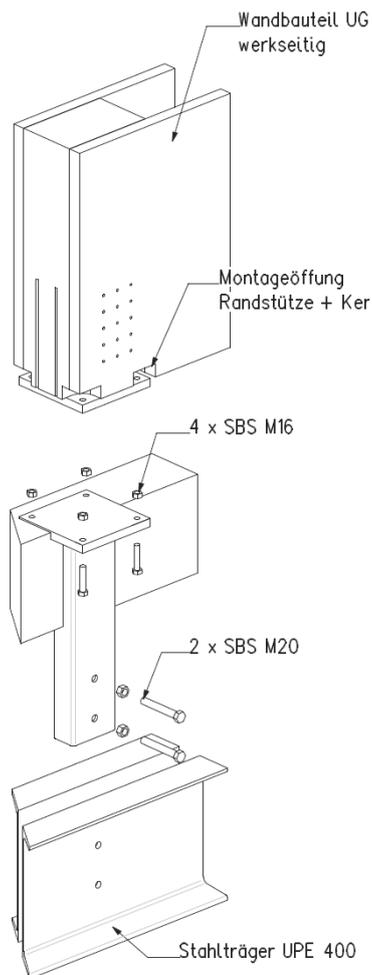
Explosionszeichnung des Stahlteils Typ 1. mit Anschluss auf den Stahlisch.
